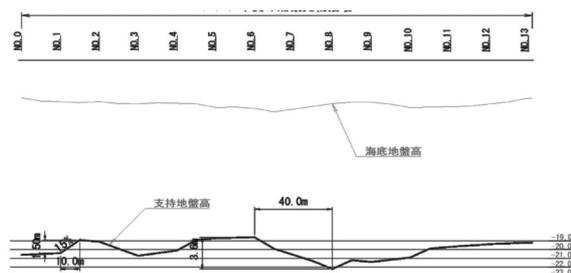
縦断面図(鋼管矢板位置岩盤探査結果)
